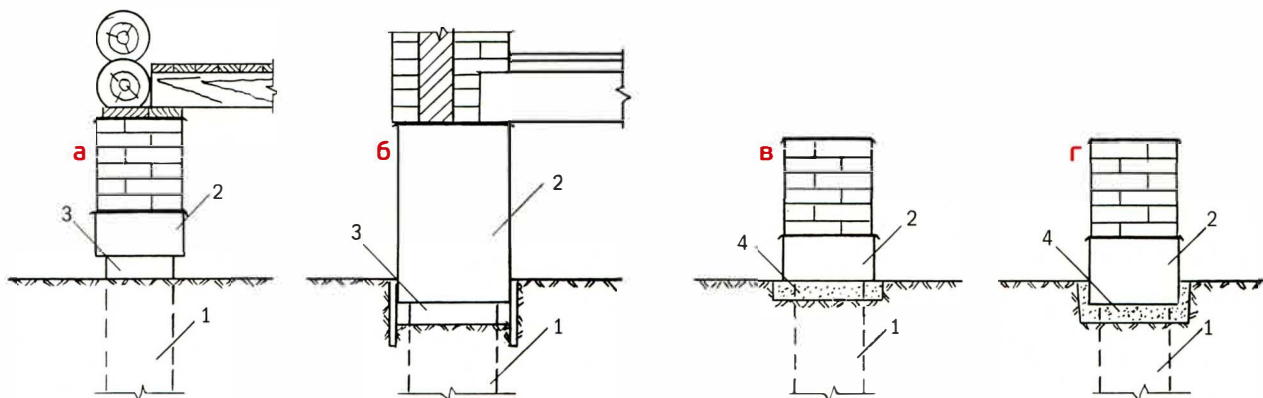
Варианты устройства цоколей: а – цоколь поднят над грунтом; б – цоколь заглублён в грунт с зазором; в, г – опирание цоколя на грунт. 1 – столбчатый фундамент; 2 – ростверк; 3 – зазор между грунтом и ростверком; 4 – песчаная выравнивающая подушка.
